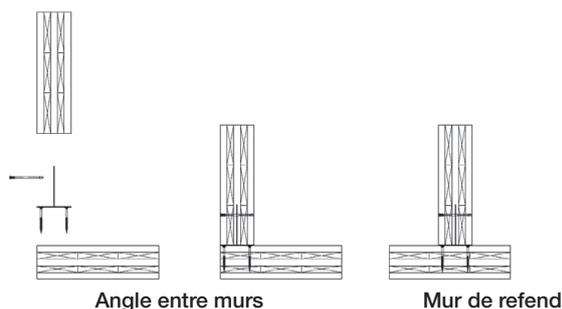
Assemblage bois-métal entre murs par plaques métalliques en âmes
